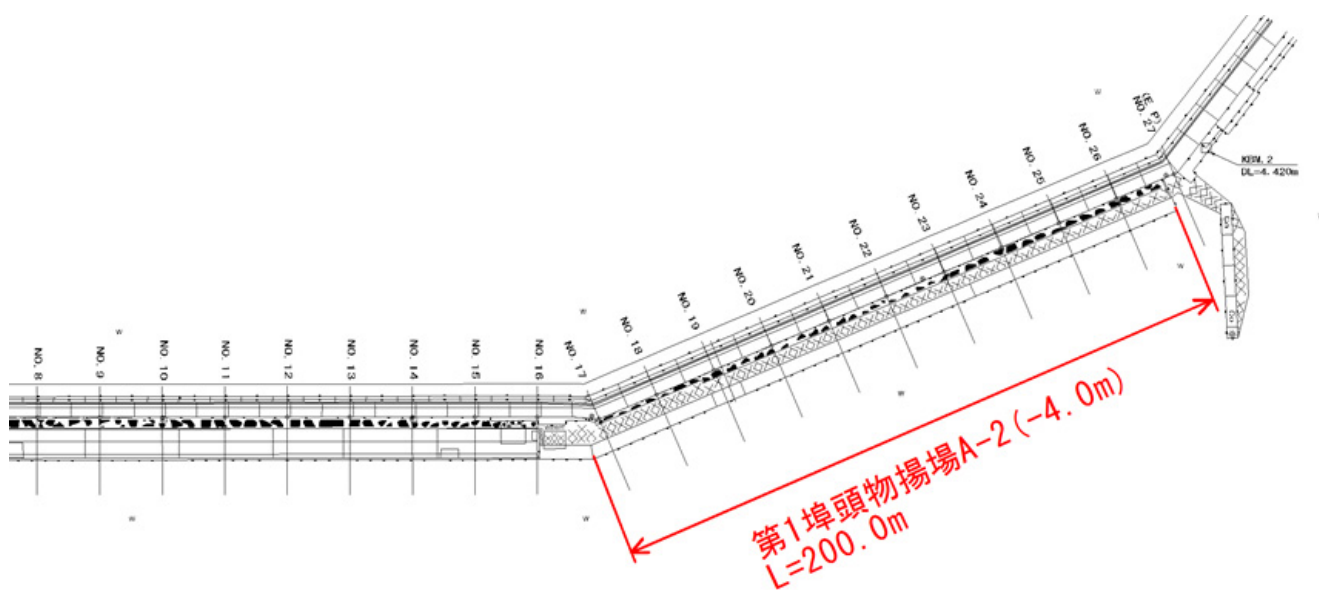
No.31 大洗港区\_第1ふ頭 A-2 物揚場 (-4.0m) の平面図 (被災前)
